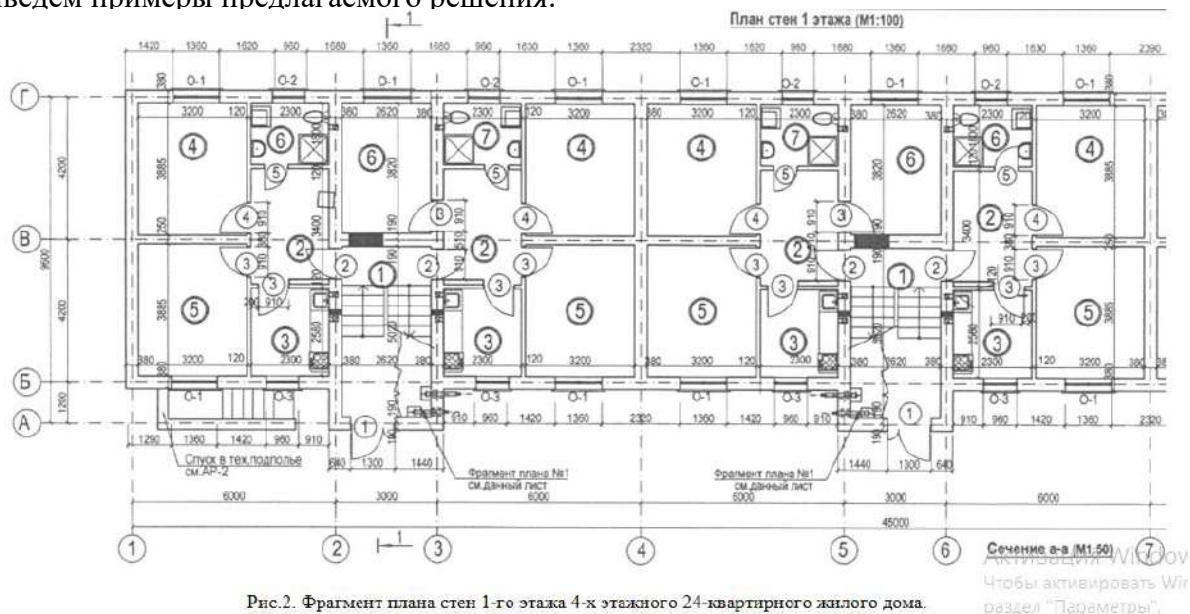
Фрагмент плана стен 1-го этажа 4-х этажного 24-квартирного жилого дома.
